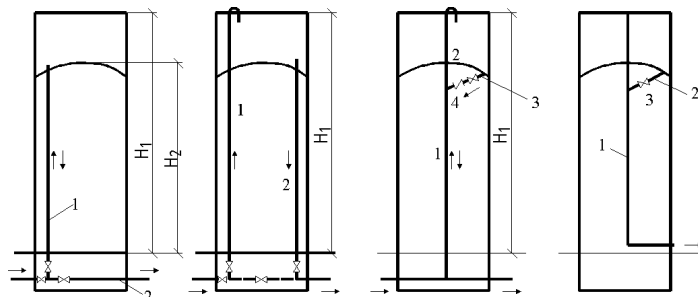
Схема обладнання трубопроводів водонапірної башти
